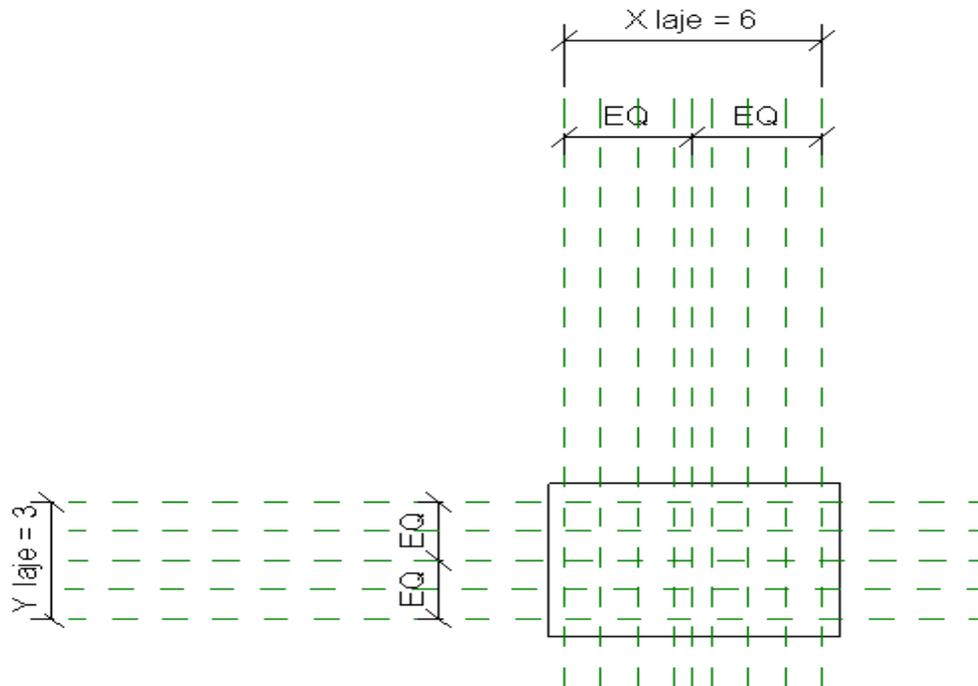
Parâmetros da laje nervurada (Autores, 2018).
